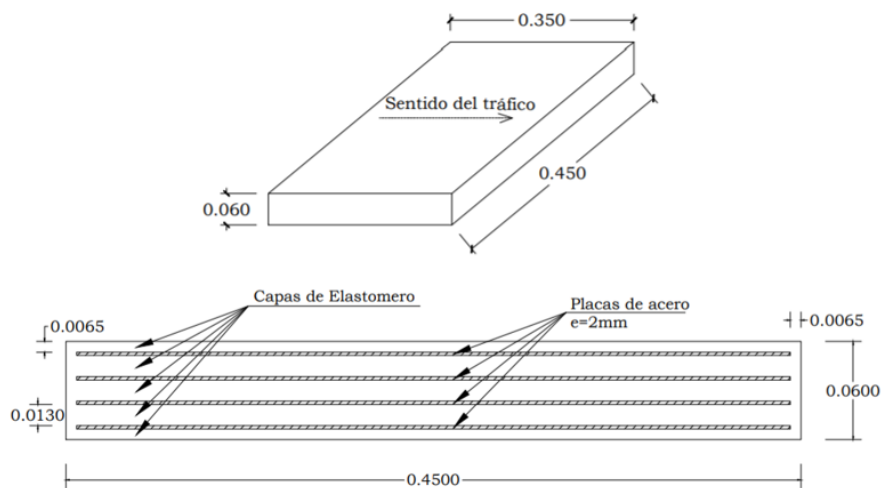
Detalle de apoyo elastómerico. Fuente: Elaboración propia
